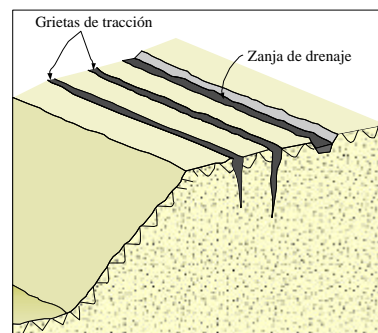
Disposición de zanjas de drenaje en un talud
